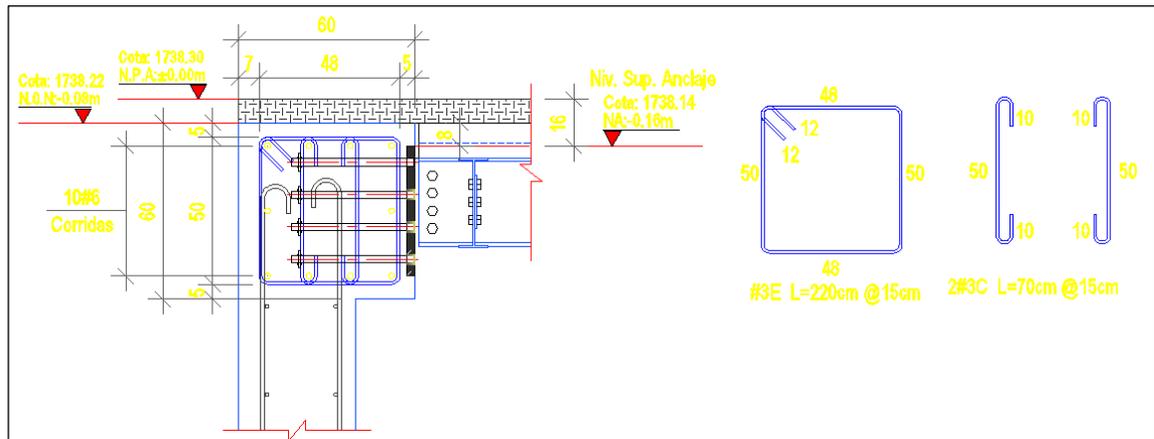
Detalle de refuerzo de viga corona e instalación de anclajes metálicos.
